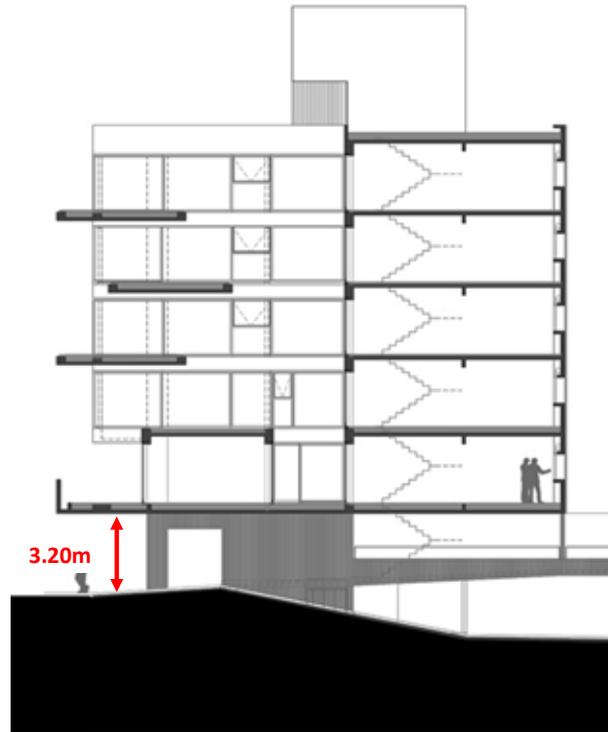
Corte longitudinal. Fuente: Imagen obtenida de la WEB
